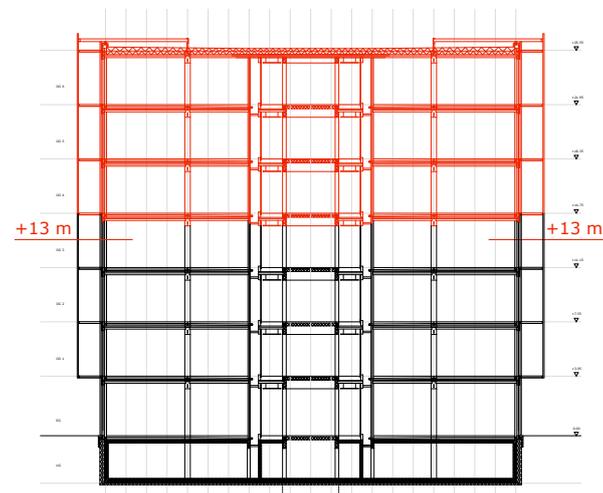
Holzbau über 13 m mit 7 Geschossen
